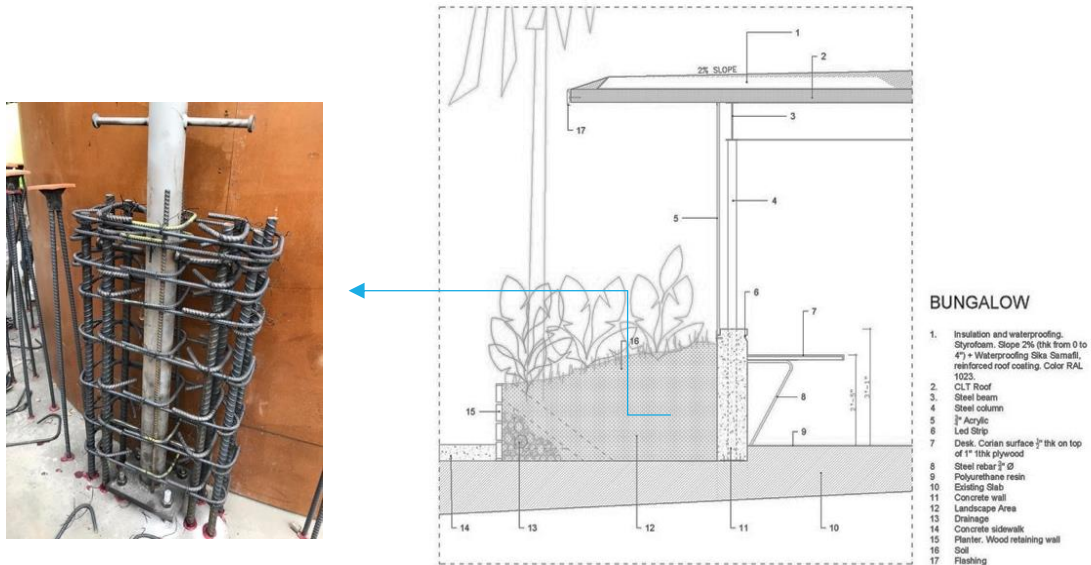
DETALLE ESTRUCTURAL DE LOS MÓDULOS HOLLA
